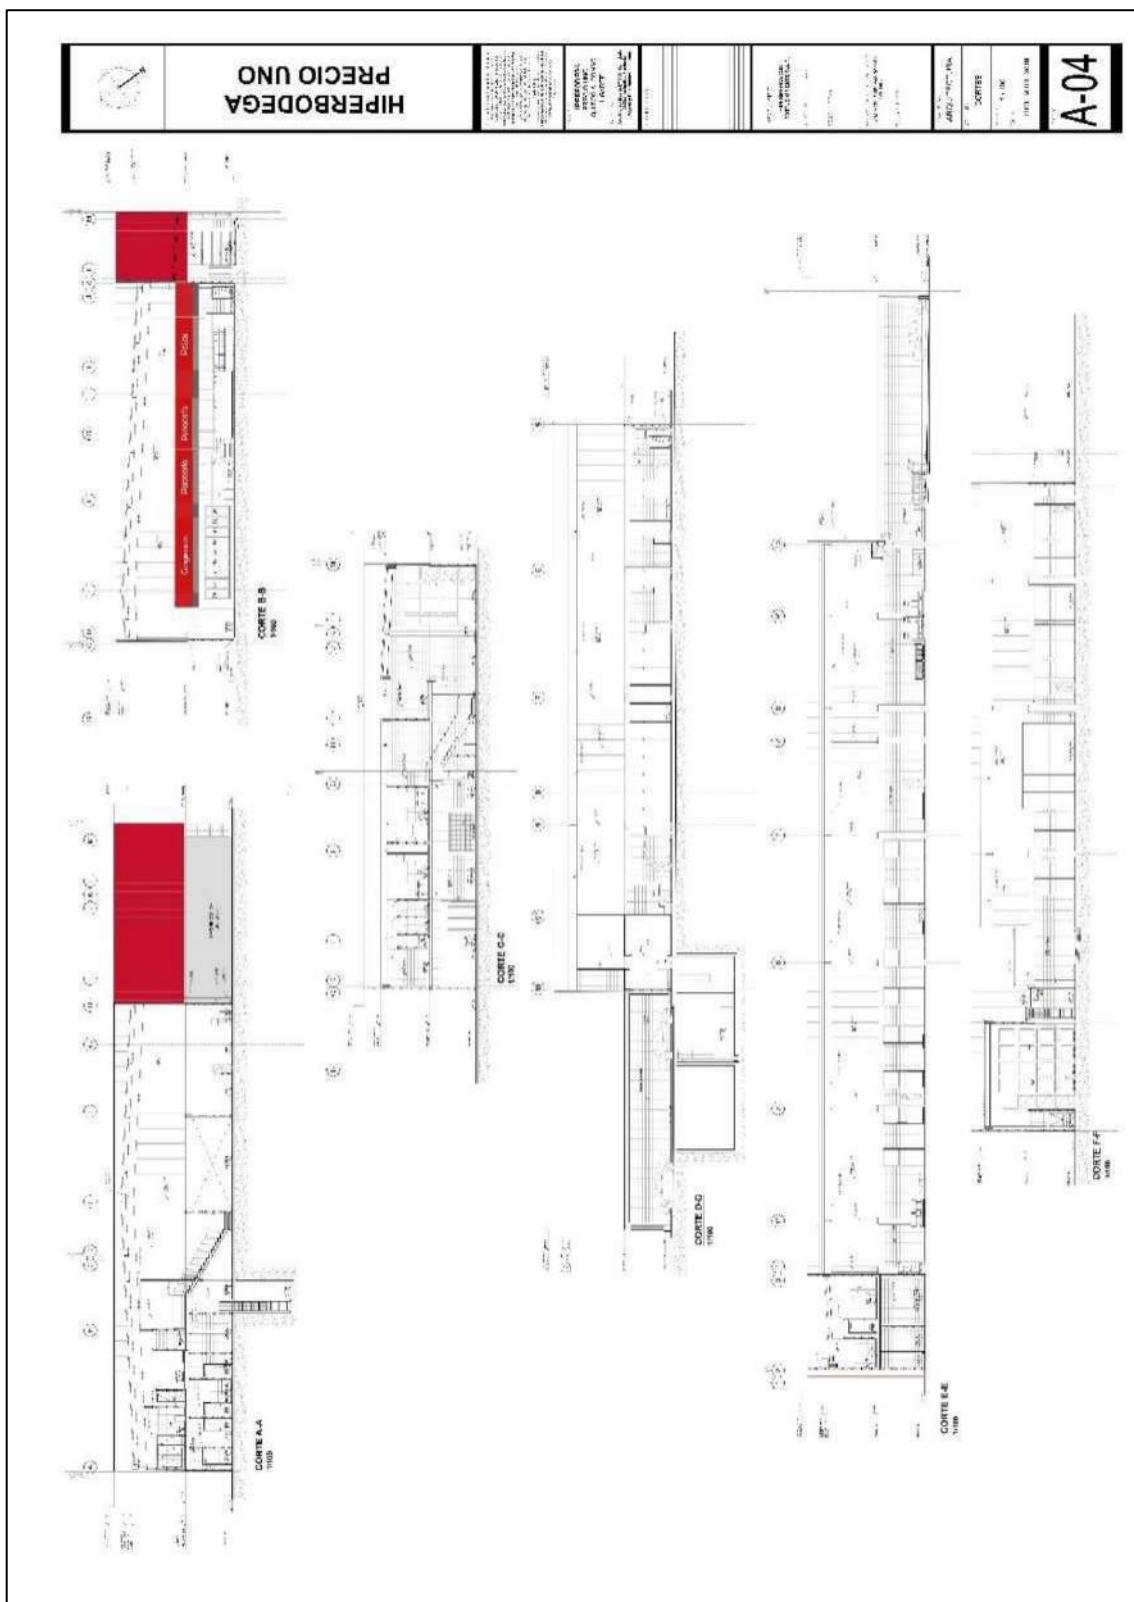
Plano Corte y Elevaciones- Iquitos Alfonso Ugarte
